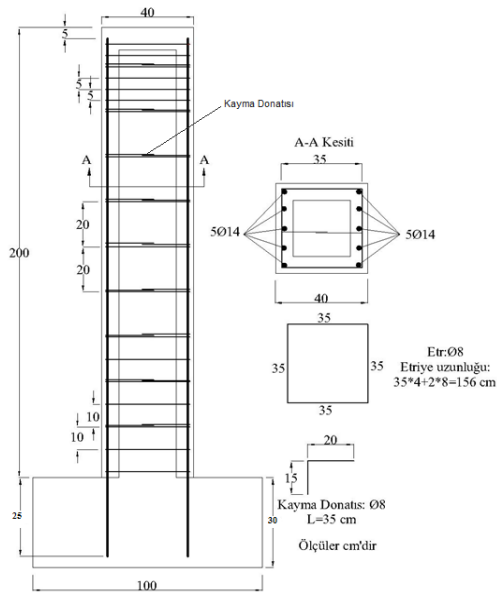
FVB deney elemanının şematik görünümü ve donatı planı (Schematic display and reinforcement plan of FVB experiment element)
